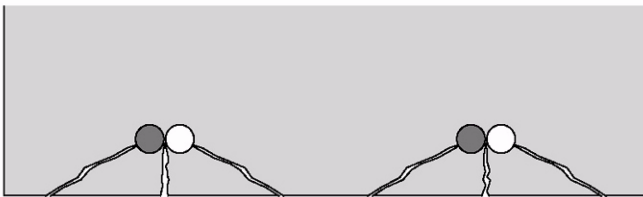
Fisuración hacia borde o *splitting
